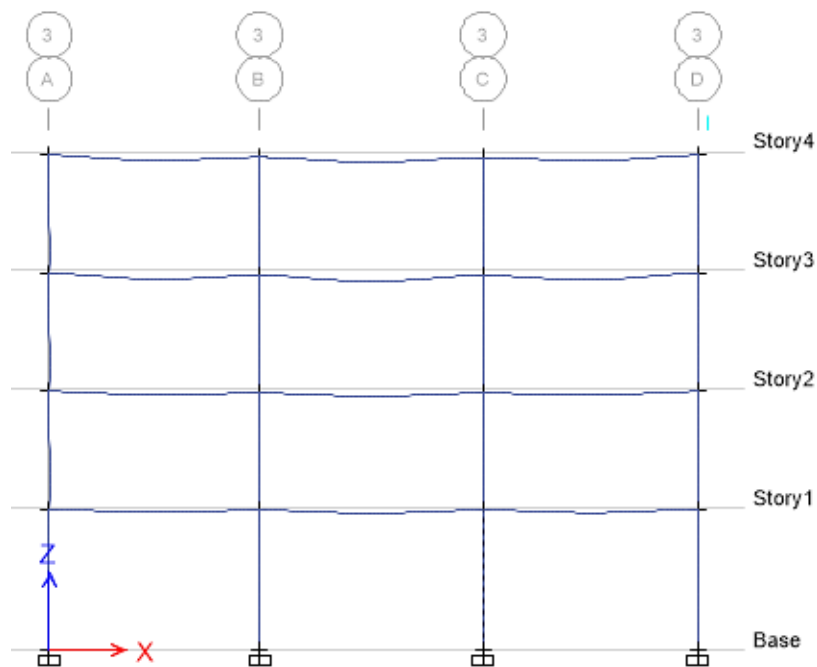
Columna C3 en planta baja. Fuente: Caiza, Pablo y Viera, Paulina; 2018
